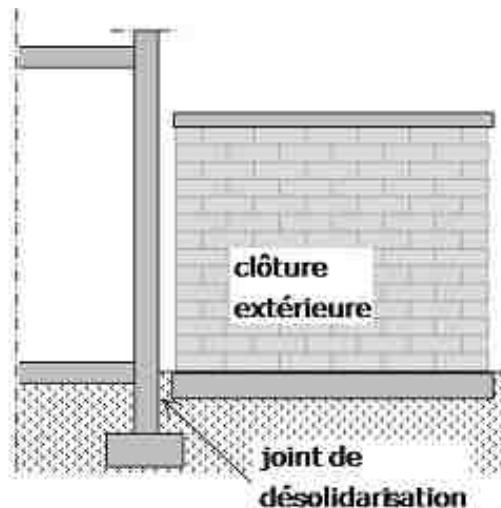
exemple de désolidarisation des fondations des ouvrages secondaires
